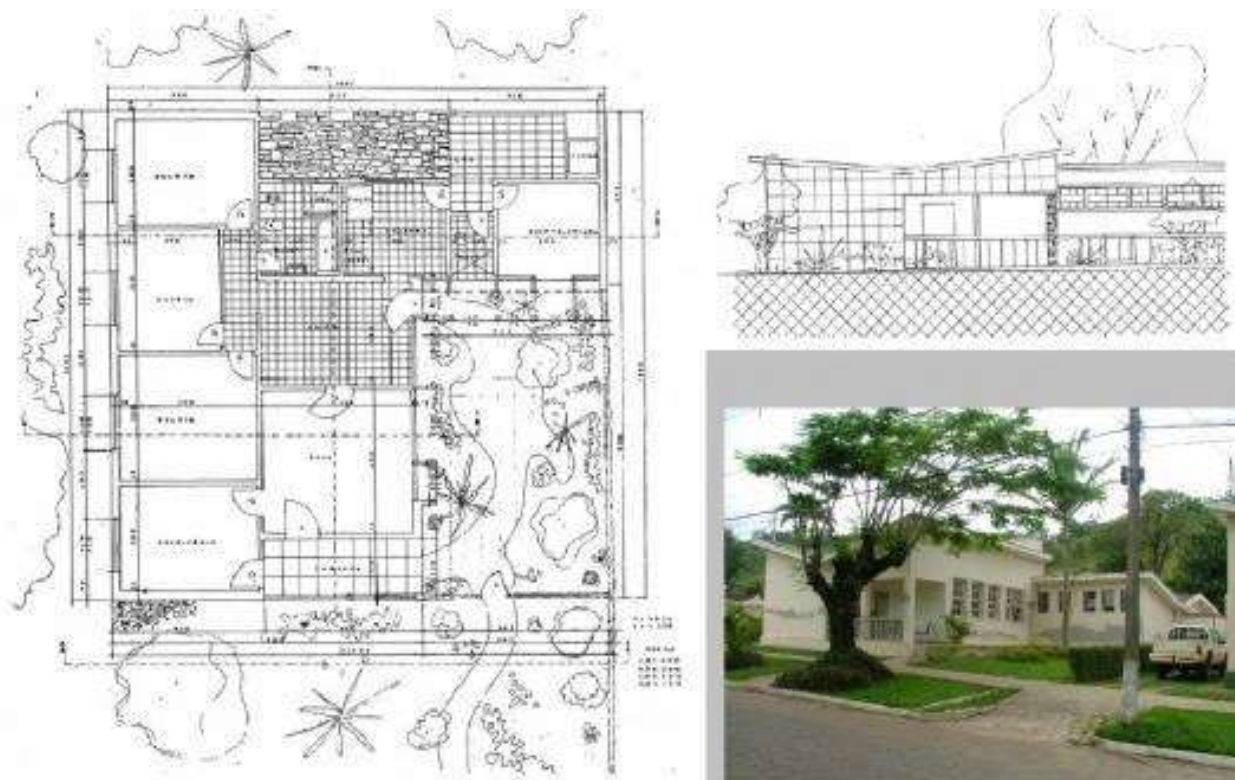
Planta baixa padrão e desenho da fachada das casas da Vila.
